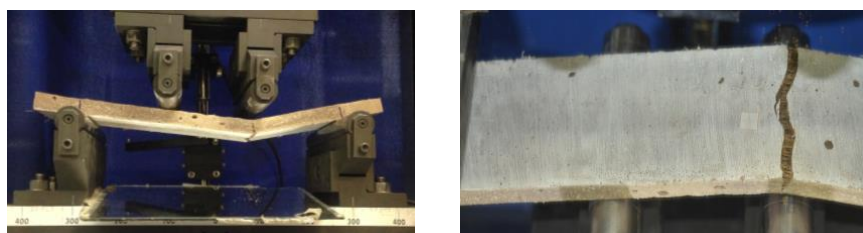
Processo de fractura durante o ensaio de flexão
